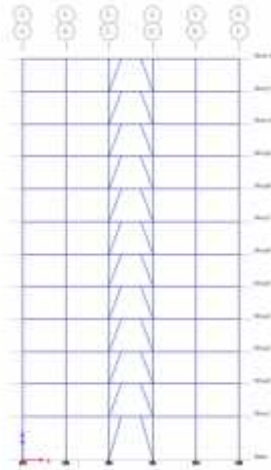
Bentuk tipikal struktur model bresing eksentris 6 lantai.
